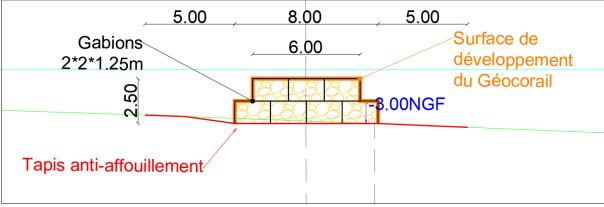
Coupe type selon A-A' du brise lames en gabions et géocorail sur la plage du Centre-Ville
